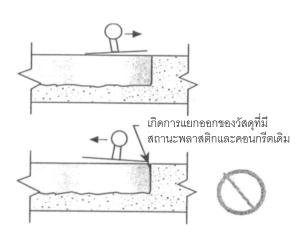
การซ่อมแซมคอนกรีตแบบ Full Depth Repair
